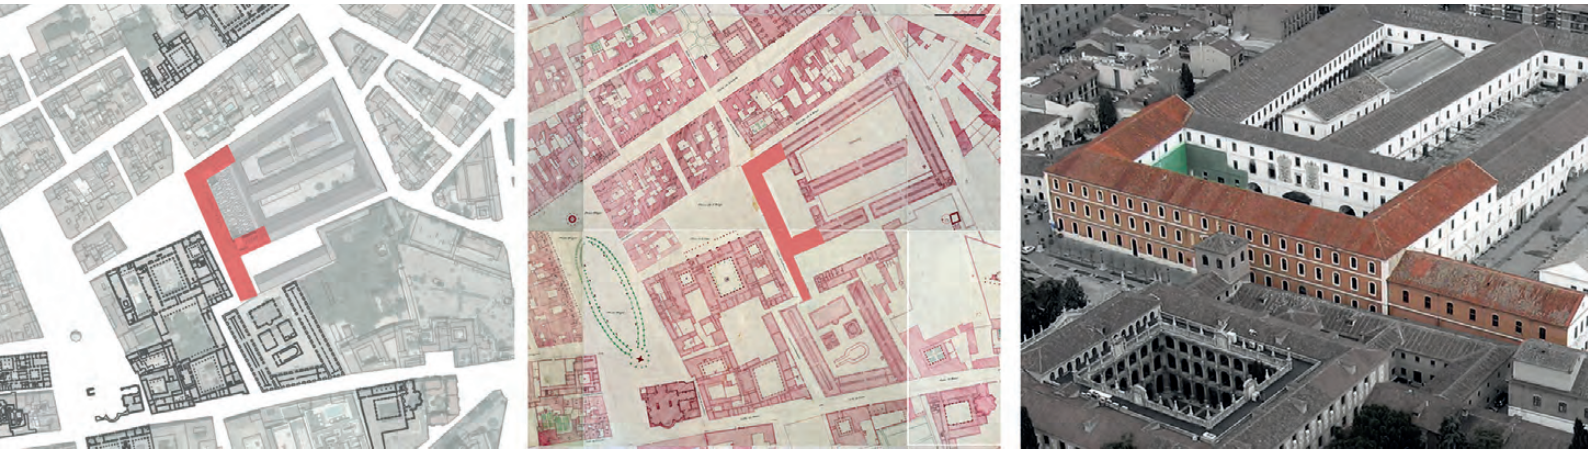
Plano de situación, plano histórico s.XIX y vista del cuartel antes de la intervención / Figure 2. Site plan, historic plan XIX century and barrack view before intervention.
